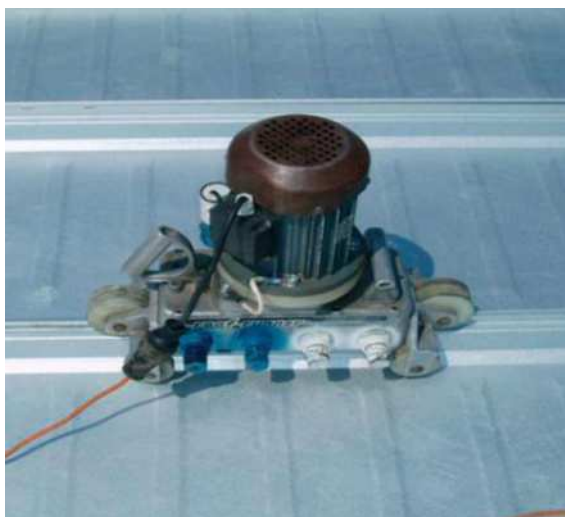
Устройство двойного фальцевого стыка закаточной машинкой
